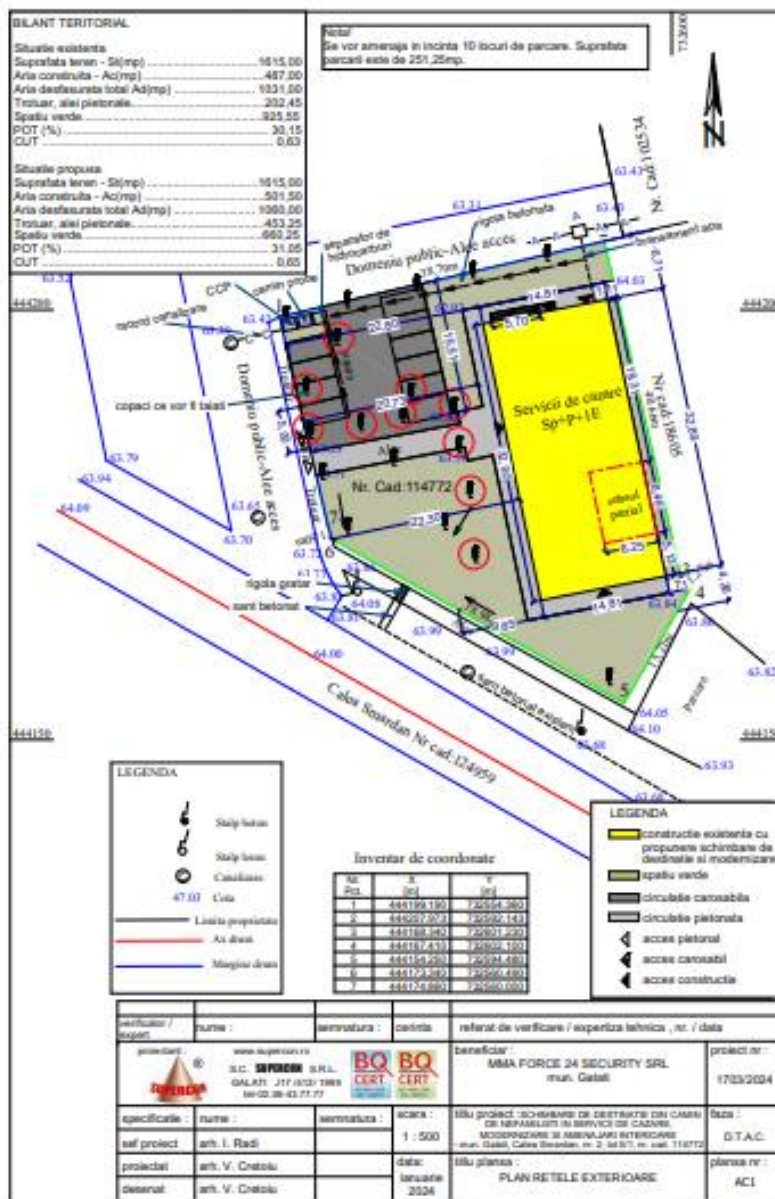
Plan Retele exterioare, plansa AC1, proiect nr.1703.20224 faza DTAC
